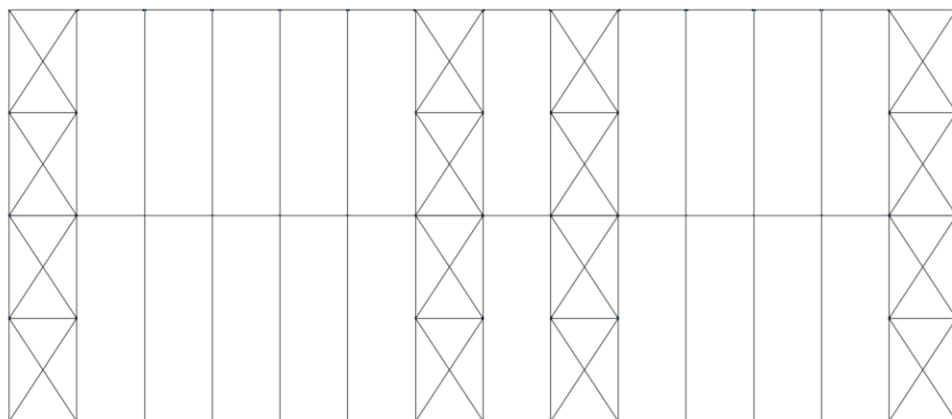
Cubierta de la nave principal
